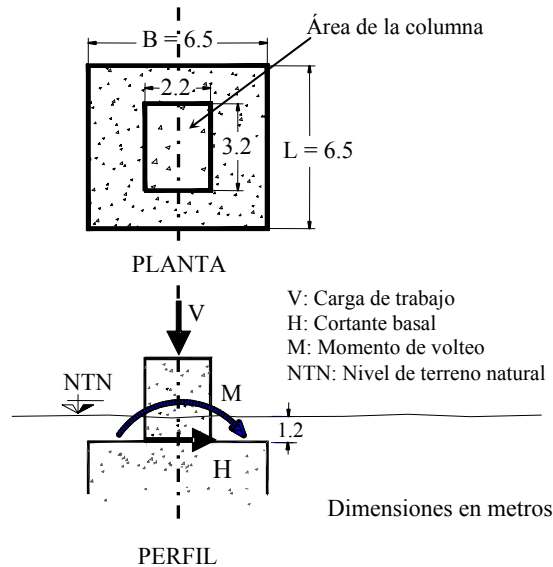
Planta de la cimentación en estudio y esquema de aplicación de las cargas
